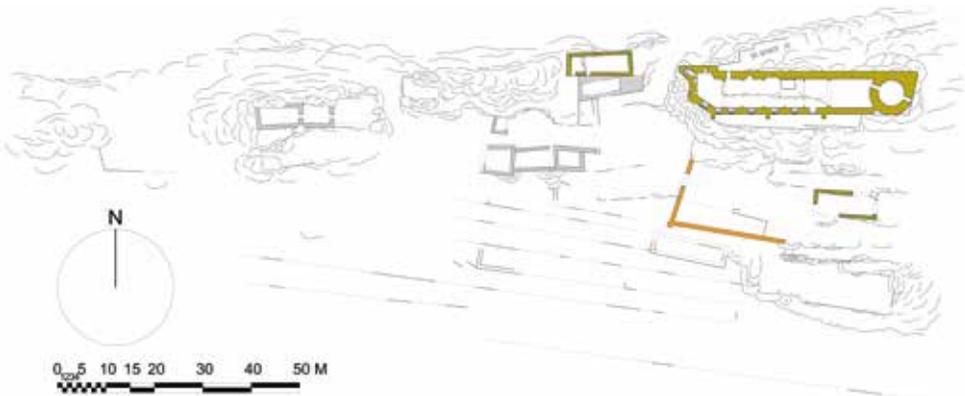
Plan du château de La Roquette : constructions de 1250 en jaune et de 1300 en orange (plan : Thomas Robardet-Caffin, 2019).
